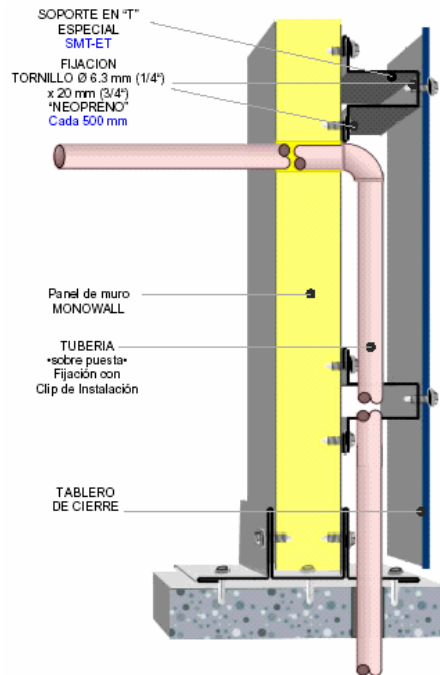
Esquema detalle de tubería sobrepuesta con tablero de acabado²
